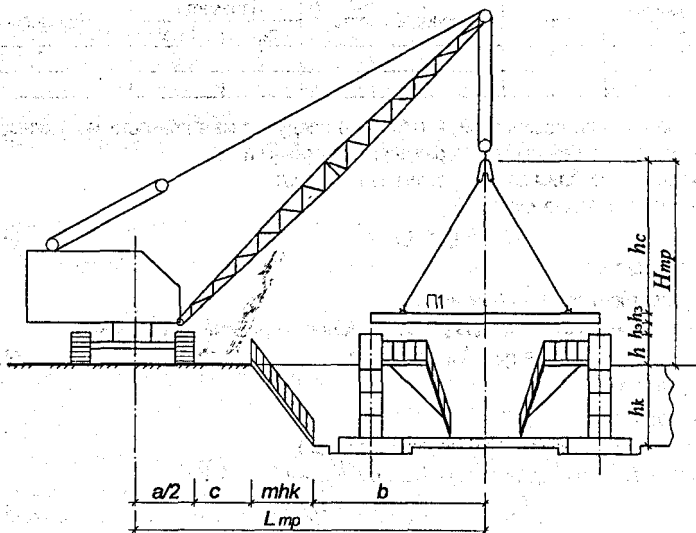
Схема к определению H_{mp} и L_{mp} при монтаже плиты перекрытия с расположением крана на бровке
